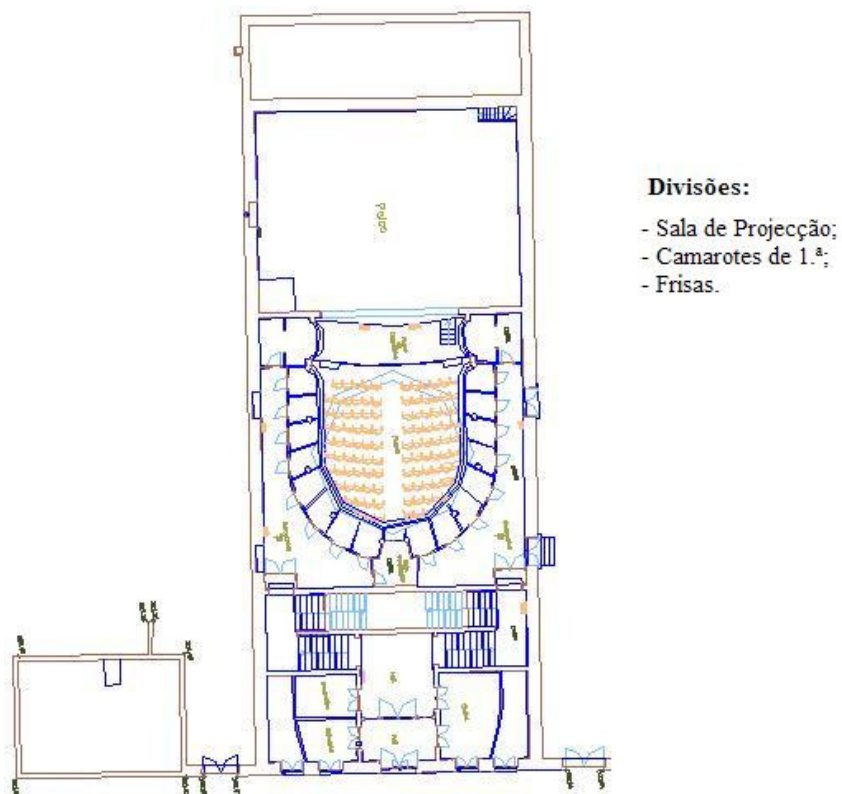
Planta do piso 1 do edifício e respectivas divisões.
